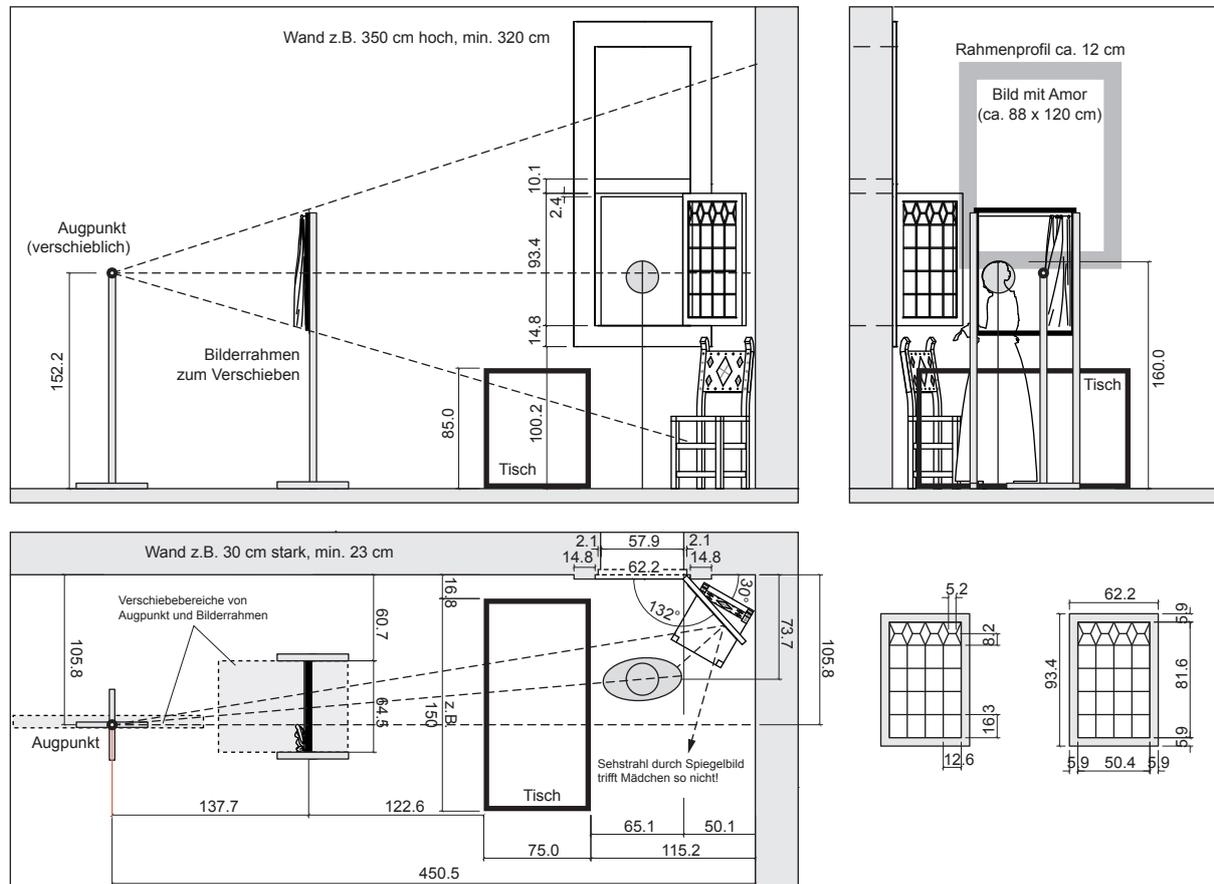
Bemaßte Risse; im Grundriss Darstellung des Sehstrahls durch die Spiegelung des Mädchenkopfes
